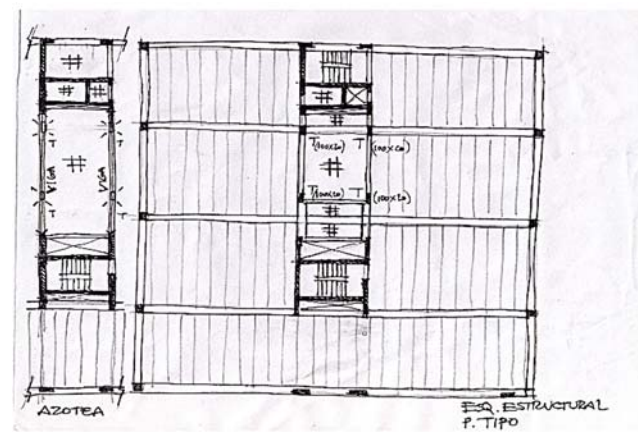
Anexo Torre Ejecutiva | Croquis propuesta de estructura - proyecto original. Esquema gentileza Arq. Javier Olascoaga.
